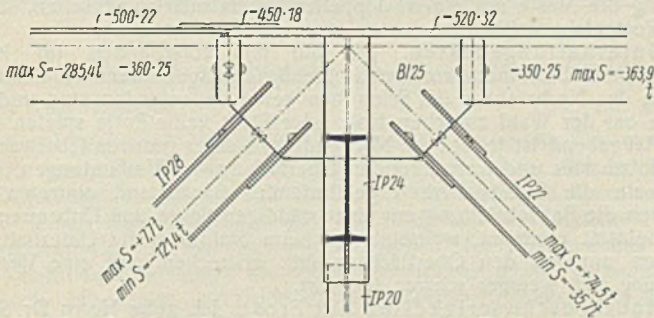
Geschweißter Obergurtnoten einer Fachwerkbrücke.
